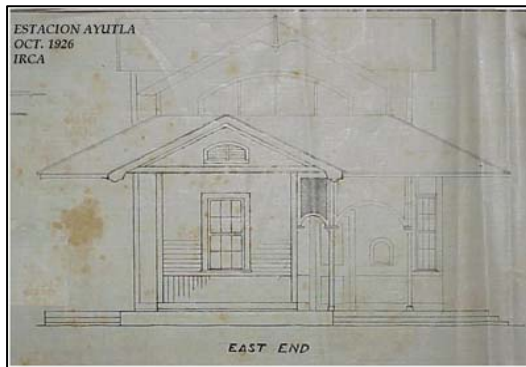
PLANO ORIGINAL DE LA ESTACION CENTRAL AYUTLA.
